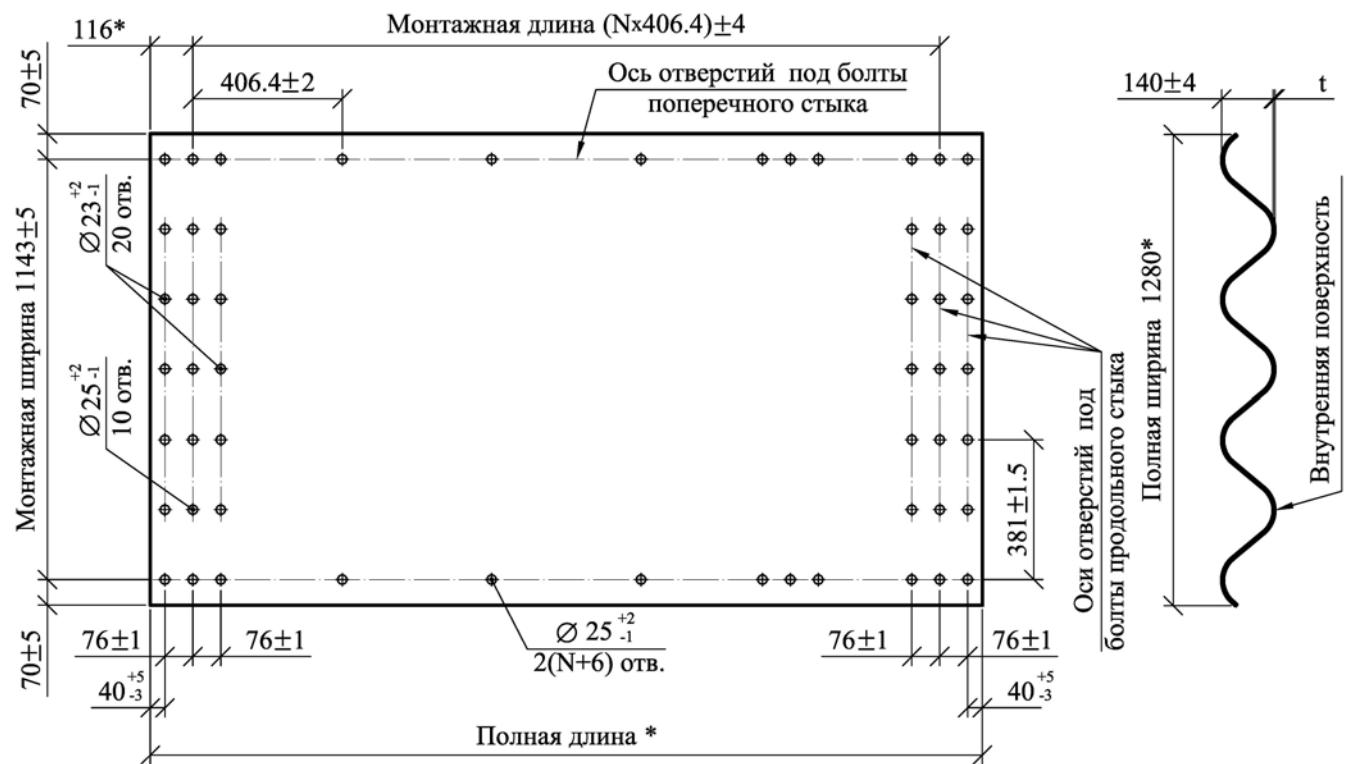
Гофрированный стальной лист ГЛ140. Вид и размеры
